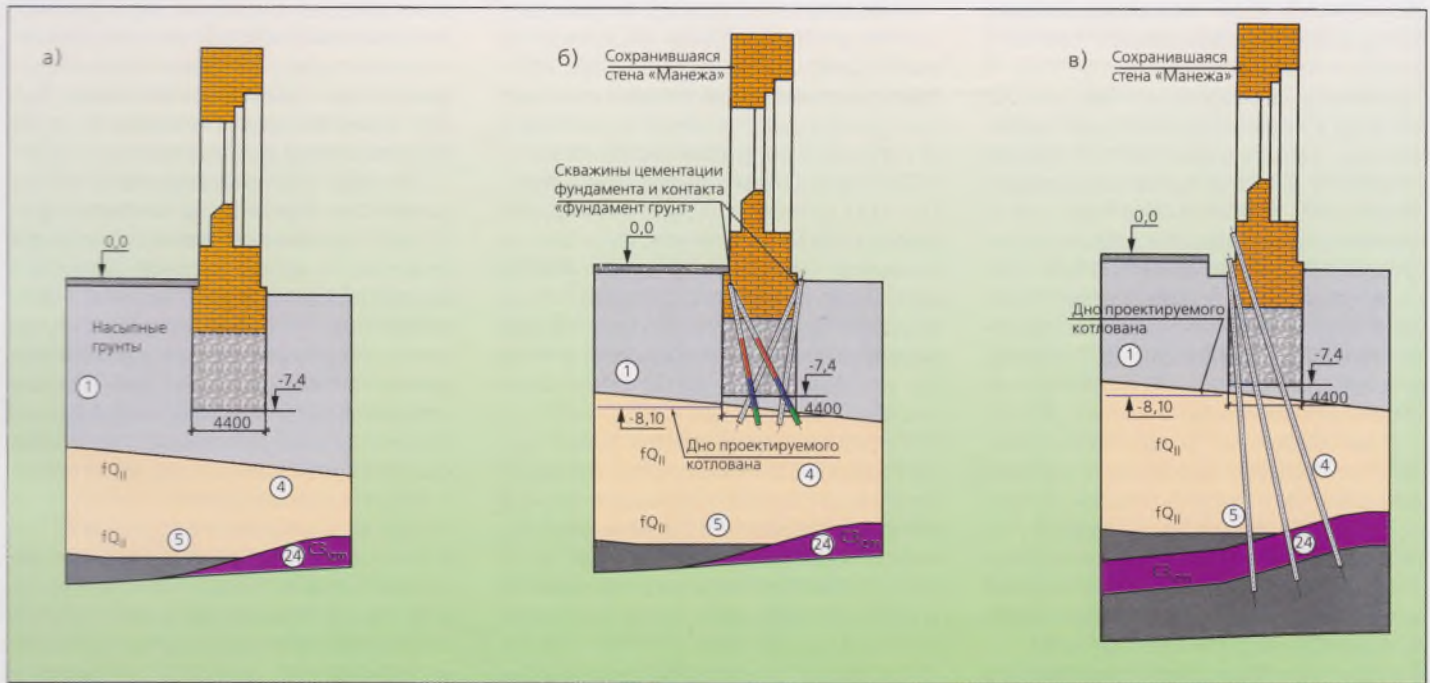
Усиление фундаментов и основания стены по Манежной улице
